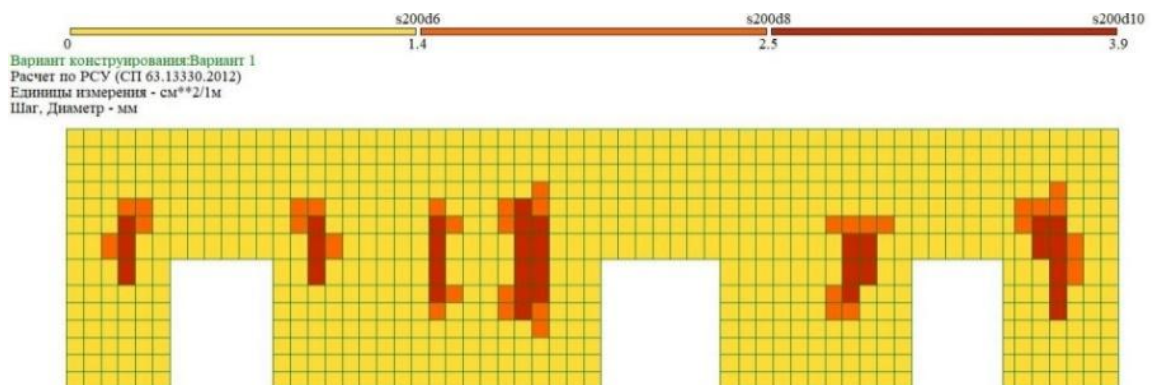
Подбор нижней продольной арматуры плиты
